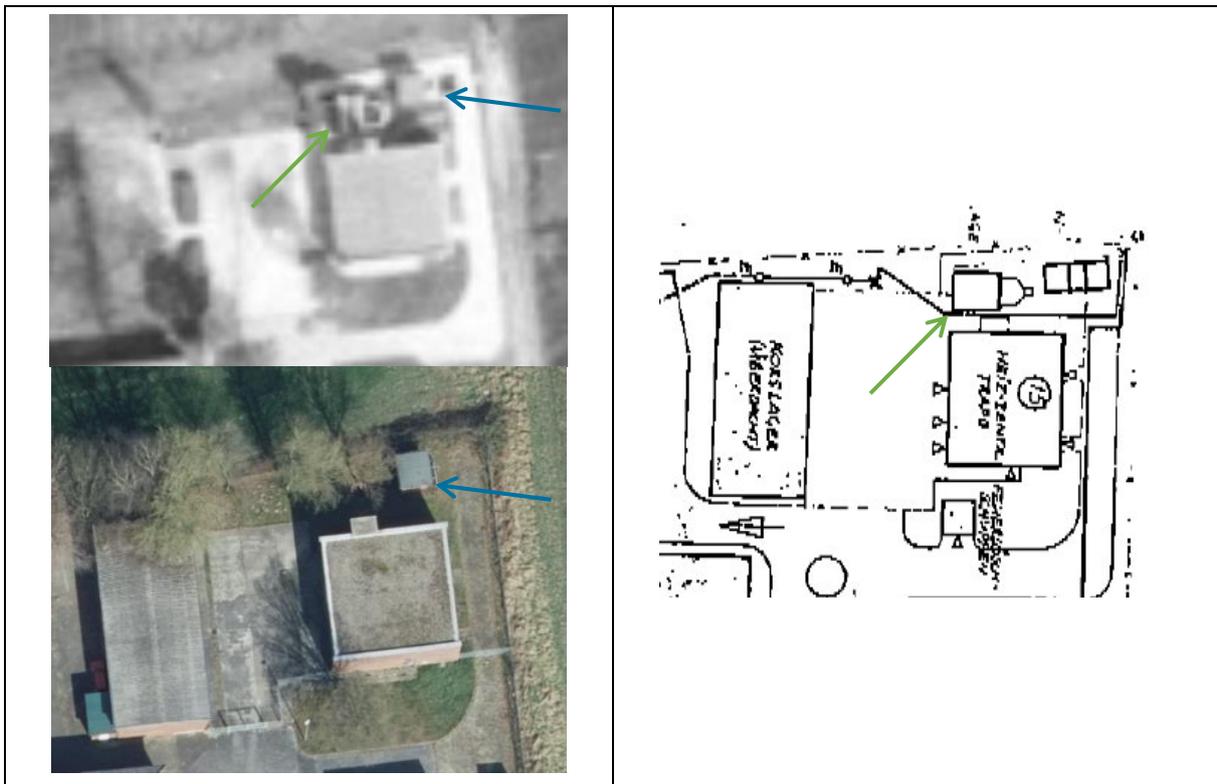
Ausschnitt aus dem Luftbild 1961 und 2018, Lageplan 2002 mit Kennzeichnung des Pumpenhauses (blauer Pfeil) und der Lagerbox (grüner Pfeil)
